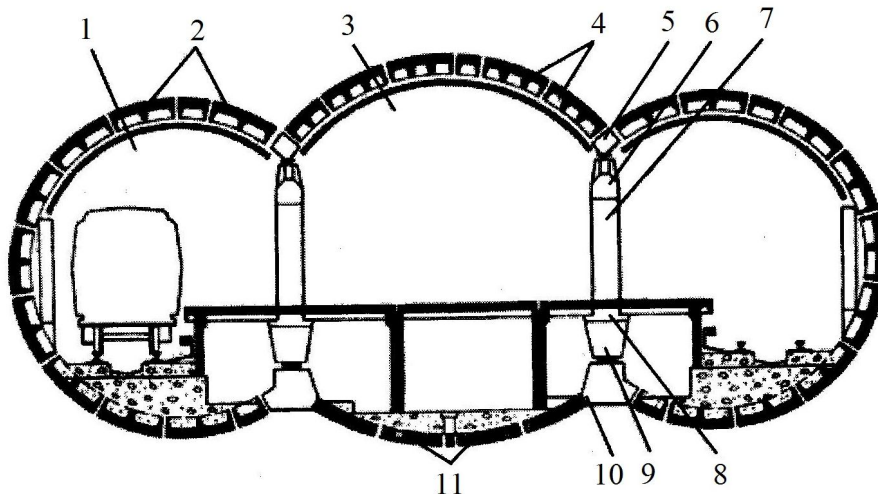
Поперечное сечение станции из сталежелезобетонных конструкций с прогонами и колоннами: 1 – боковой станционный тоннель; 2 – разомкнутая обделка станционного тоннеля из железобетонных тубингов диаметром 8,5 м; 3 – средний тоннель с разомкнутой обделкой; 4 – верхний свод среднего тоннеля из железобетонных тубингов диаметром 9,8 м; 5 – чугунный тубинг; 6 – прогон; 7 – колонна; 8 – стальной опорный башмак; 9 – нижний неразрезной монолитный прогон; 10 – железобетонный блок; 11 – нижний свод среднего тоннеля из железобетонных блоков
